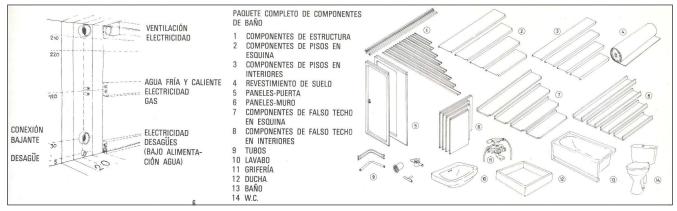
Unidad Separable. Sistemas constructivos e infraestructuras (fuente: Kendall y Teicher 1999).
